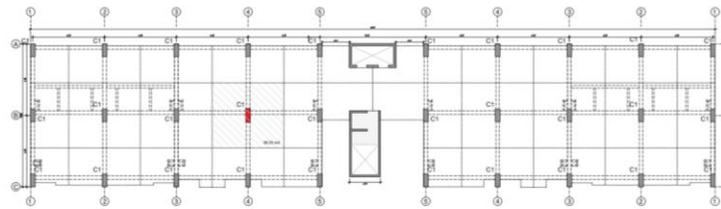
Plano de dimensionamiento FUENTE: Elaboración propia
